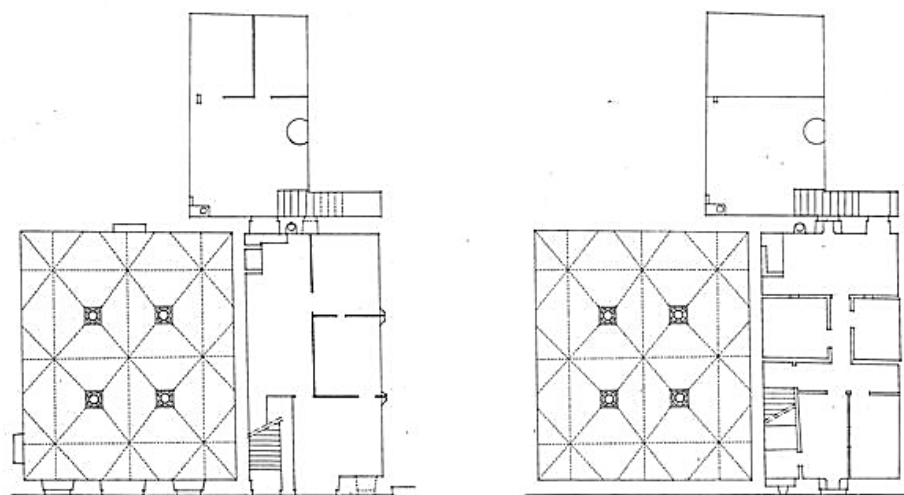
Plantas da Sinagoga de Tomar, onde se evidenciam as salas adossadas ao edifício principal: à esquerda o primeiro pavimento e à direita o segundo pavimento [20].
